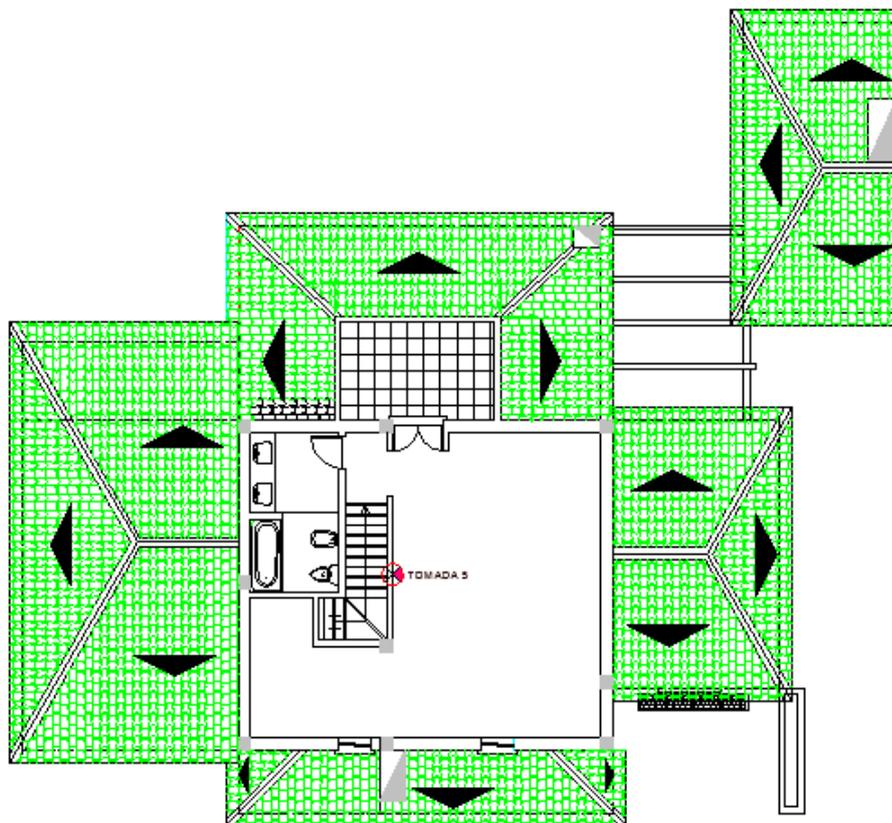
1º Andar – Traçado e Dimensionamento em planta
